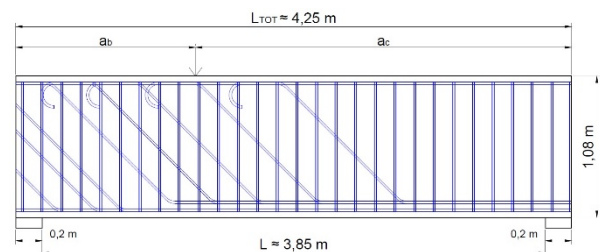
Geometría, armado y esquema de carga de las vigas T cortas.
